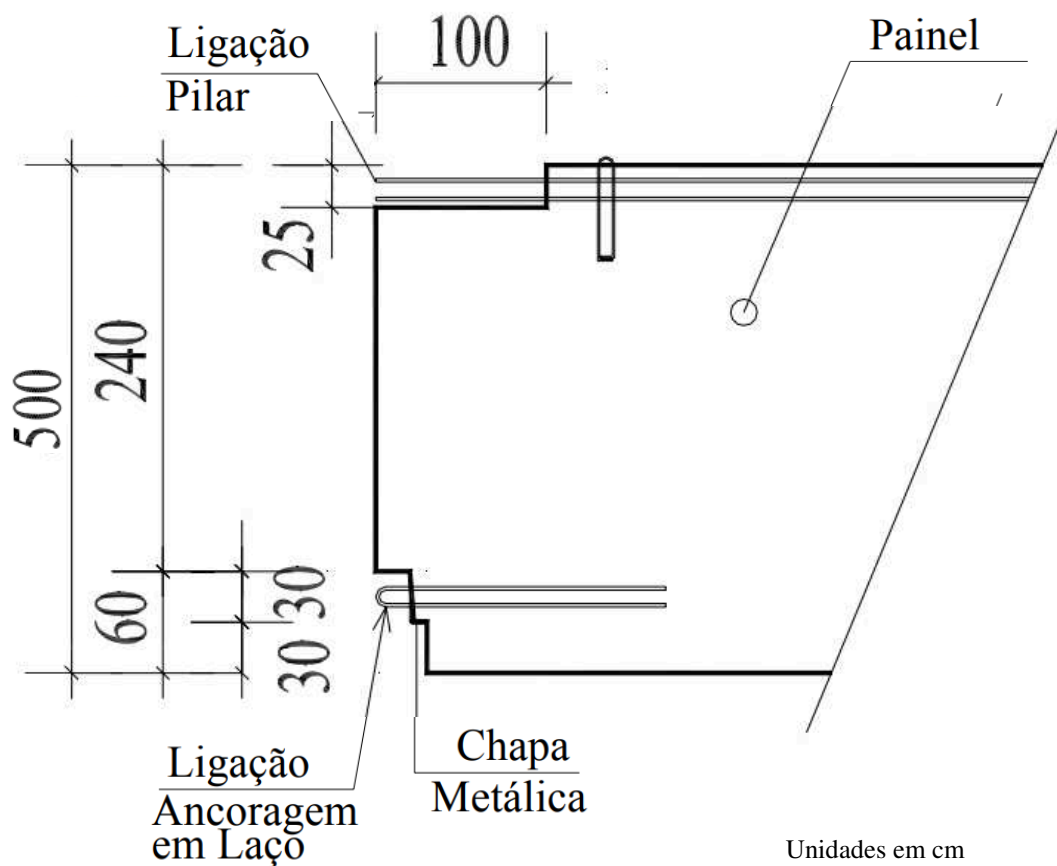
Halfen, dispositivo de fixação horizontal dos painéis de vedação.
